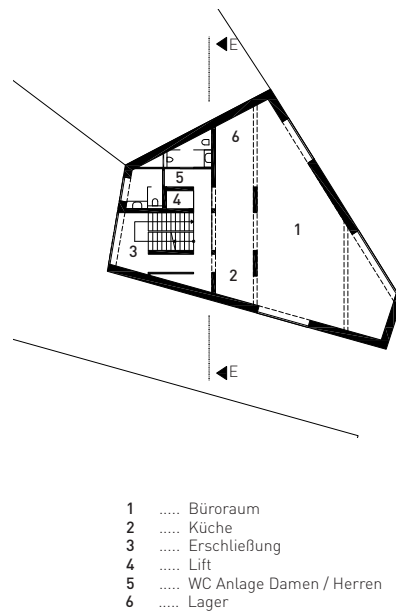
Grundriss Verwaltungsgebäude 1.OG +6,70m
